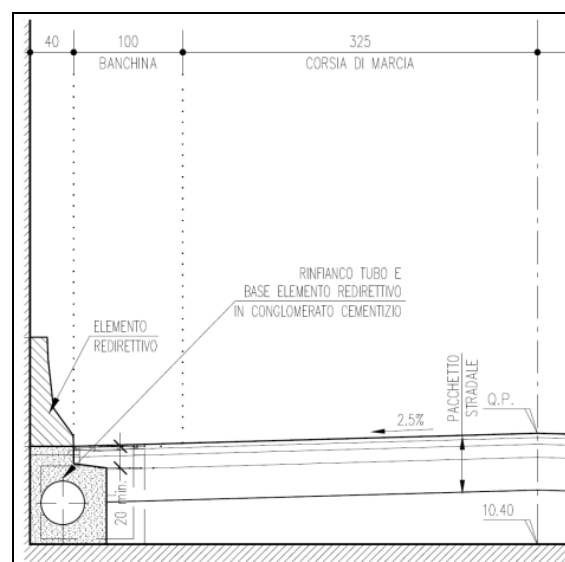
PARTICOLARE POSIZIONAMENTO CANALETTA
